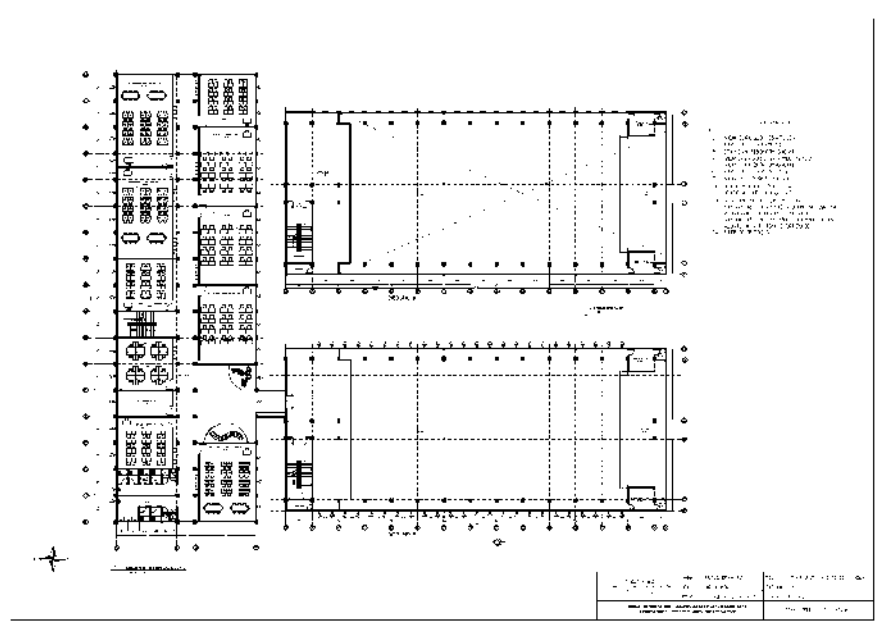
Pengembangan layout terpilih lantai 1
